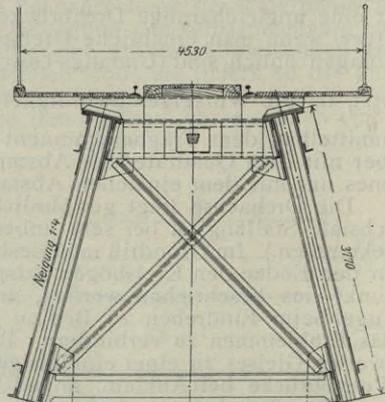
Drehbrücke mit obenliegender Fahrbahn. (Österröndfeld.)
